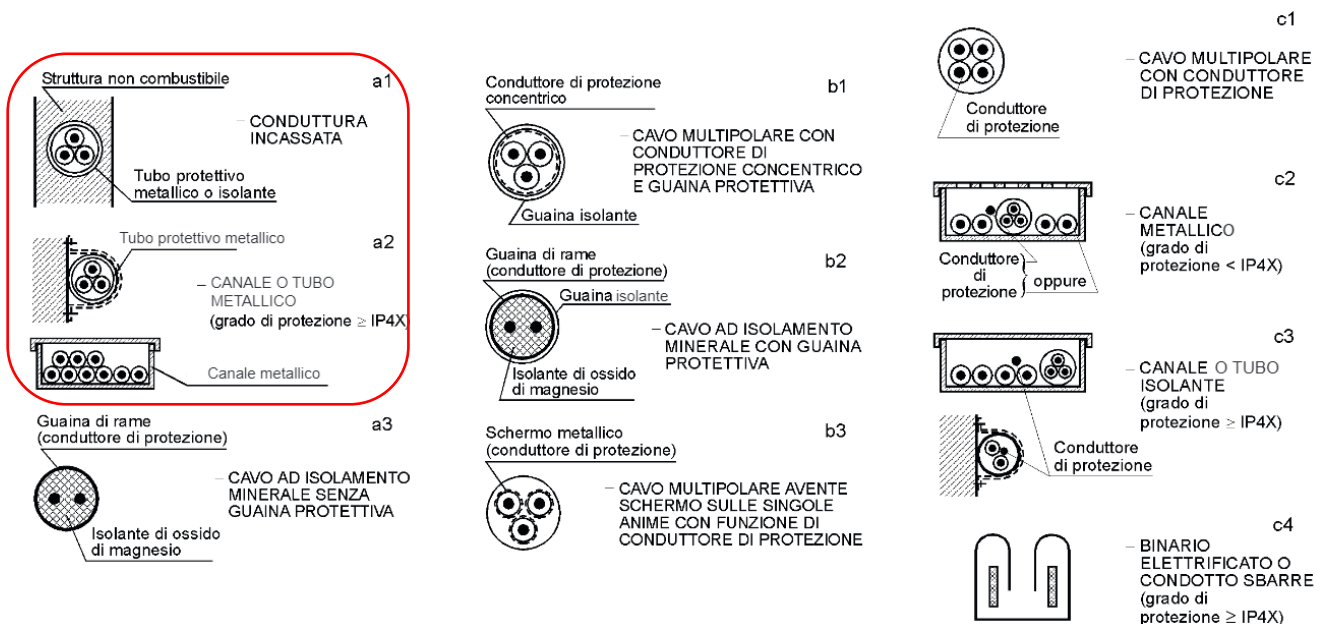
Modalità di posa delle condutture consentite (Fonte CEI 64/8 sezione 751.04.2.6)
